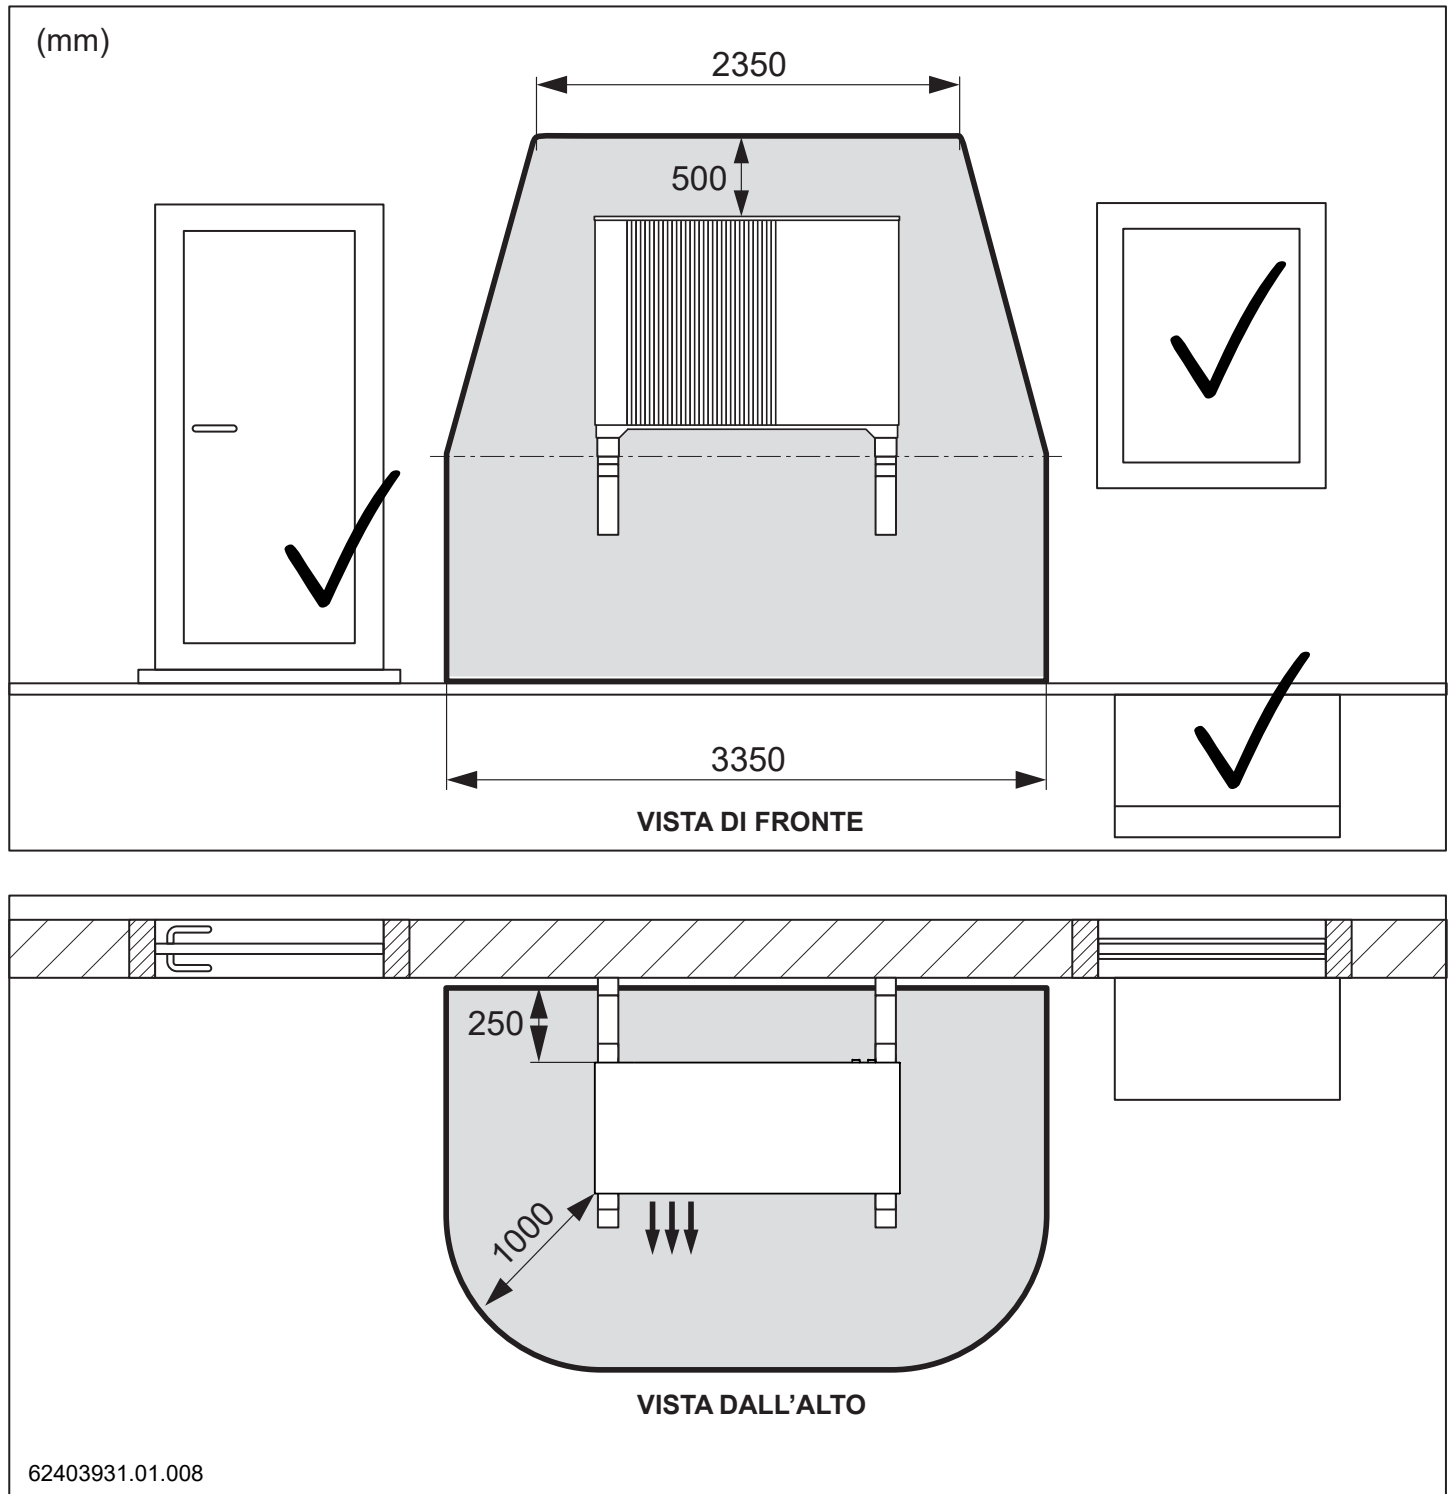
Installazione a parete davanti a una parete (misure in mm)
